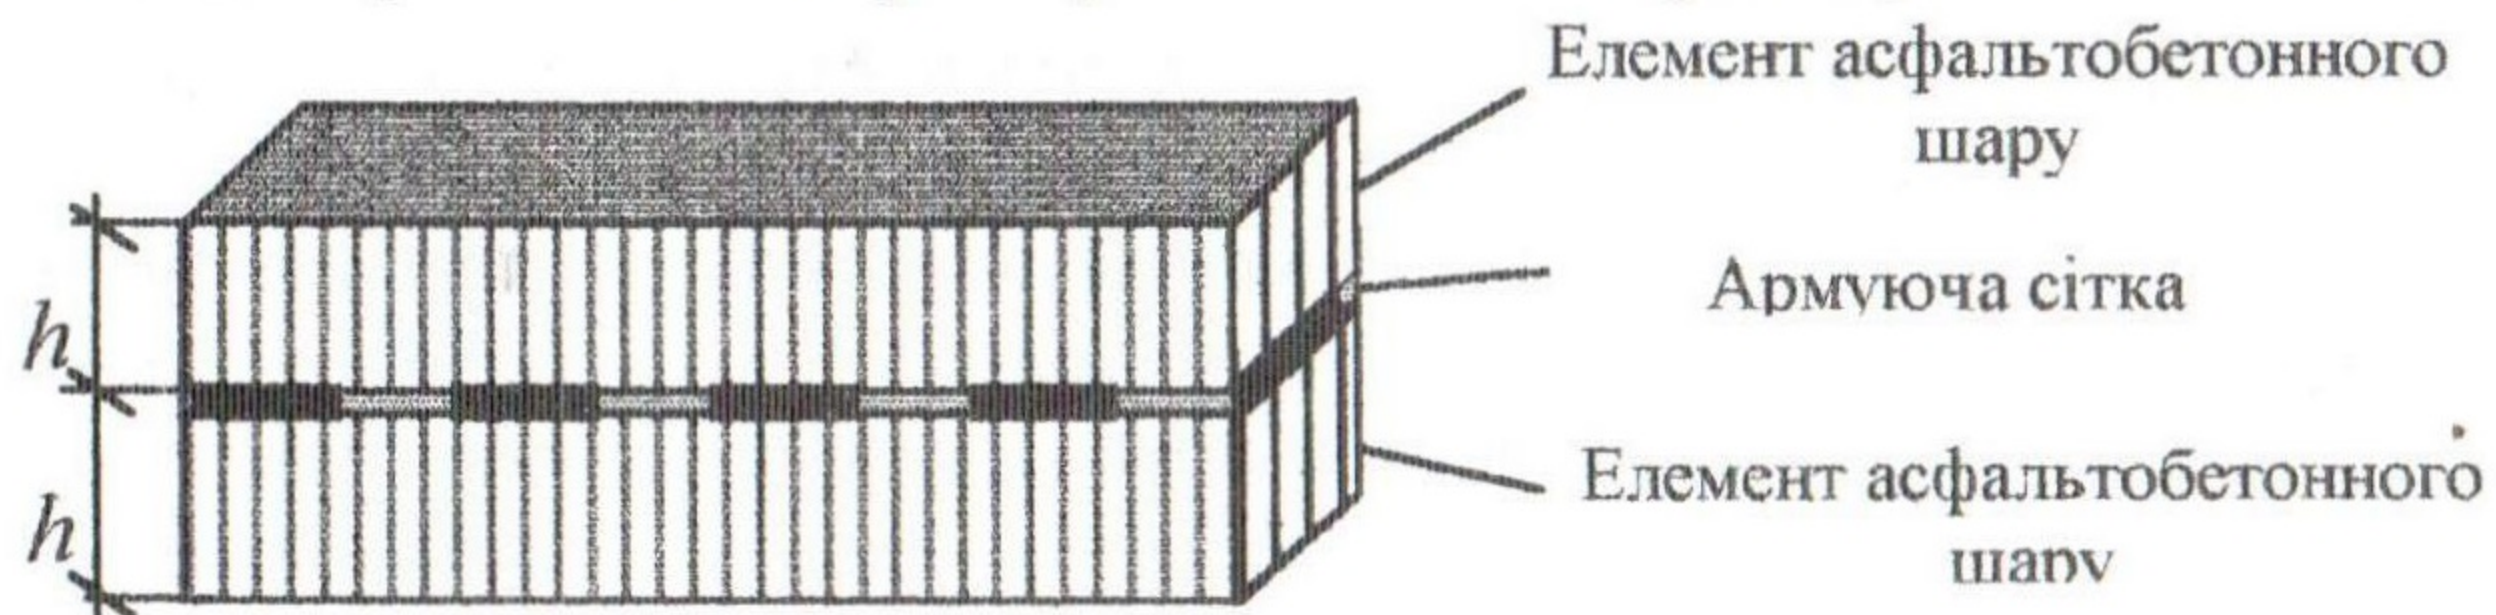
Схема конструкції армованого асфальтобетонного зразка:
